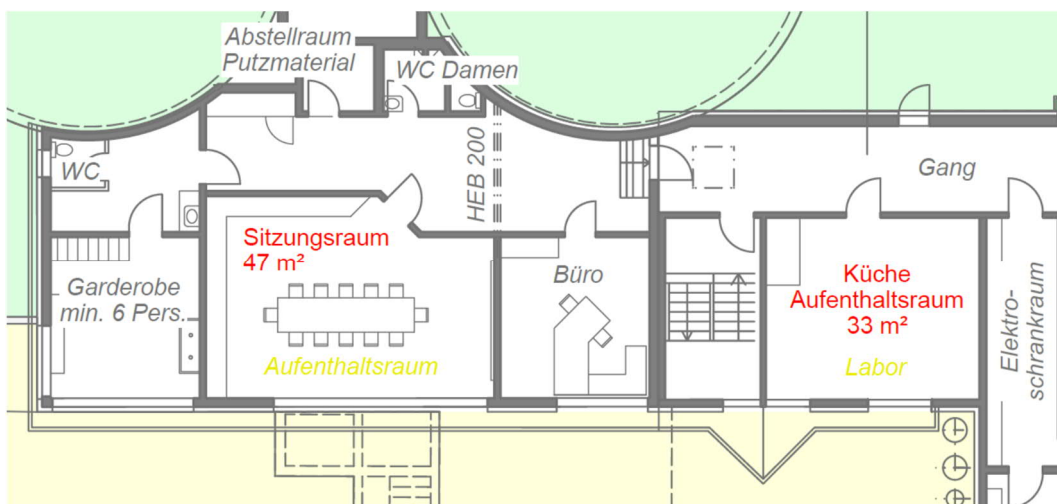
Planausschnitt; Grundriss OG
